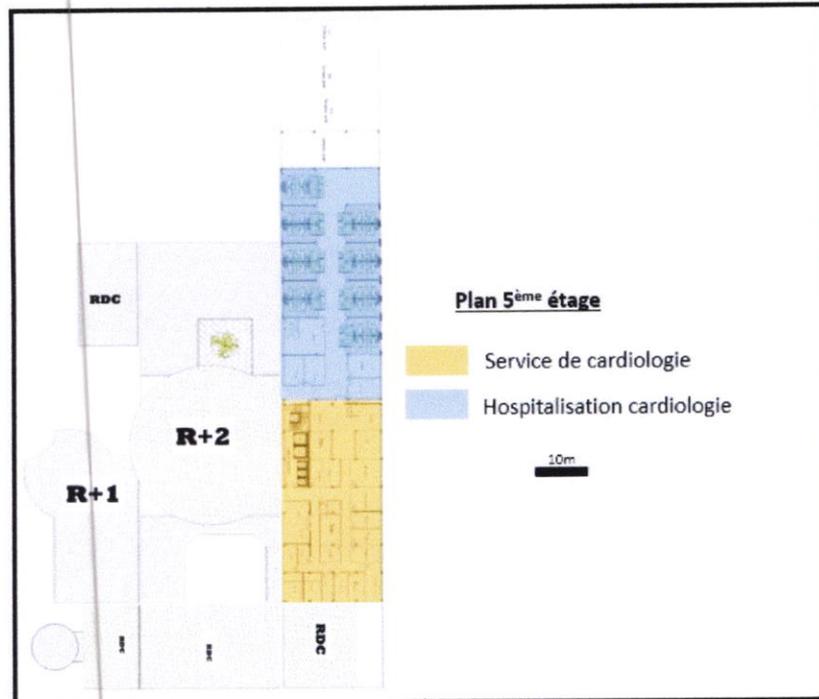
Plan 5<sup>ème</sup> étage-Agencement des unités fonctionnelles Source : Auteurs
